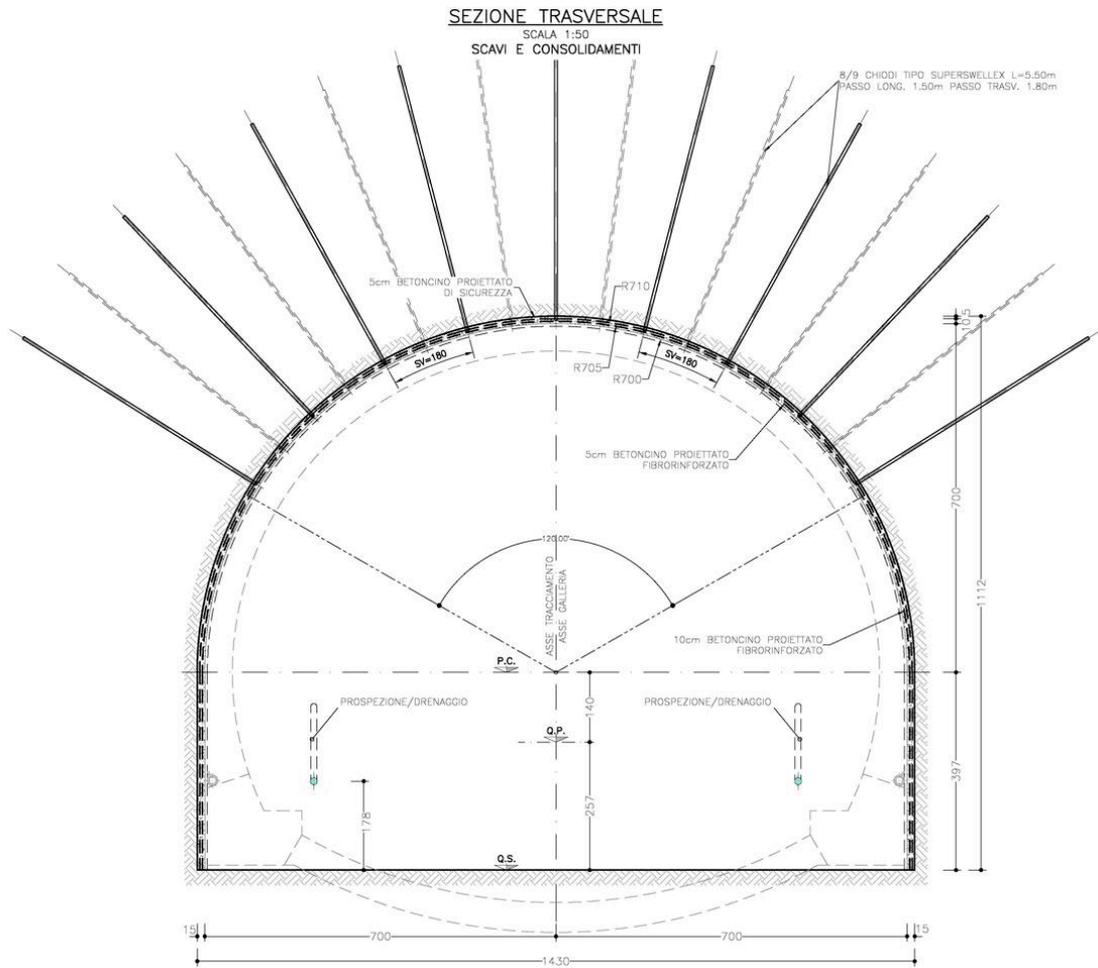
Sezione GN-A1 – Sezione di scavo.
